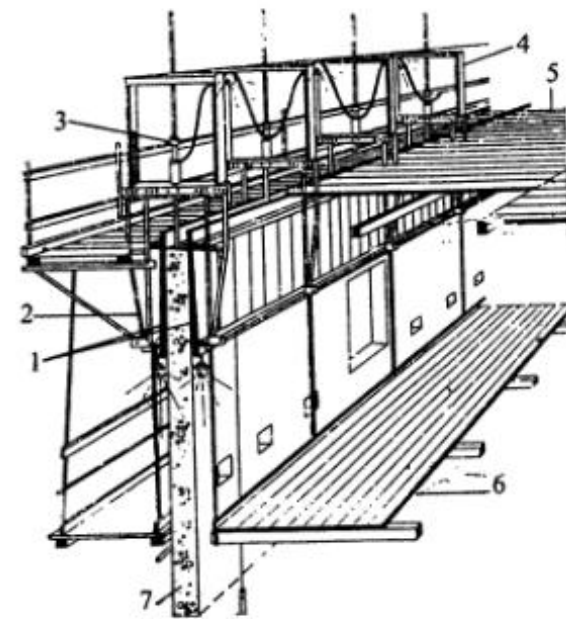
Схема возведения бетонной стены в скользящей опалубке: 1 - щит опалубки, 2 - домкратная рама, 3 - домкрат и домкратный стержень, 4 - платформа для хранения домкратных стержней, 5 - верхний рабочий пол, 6 - нижний рабочий пол, 7 - стена из монолитного бетона
